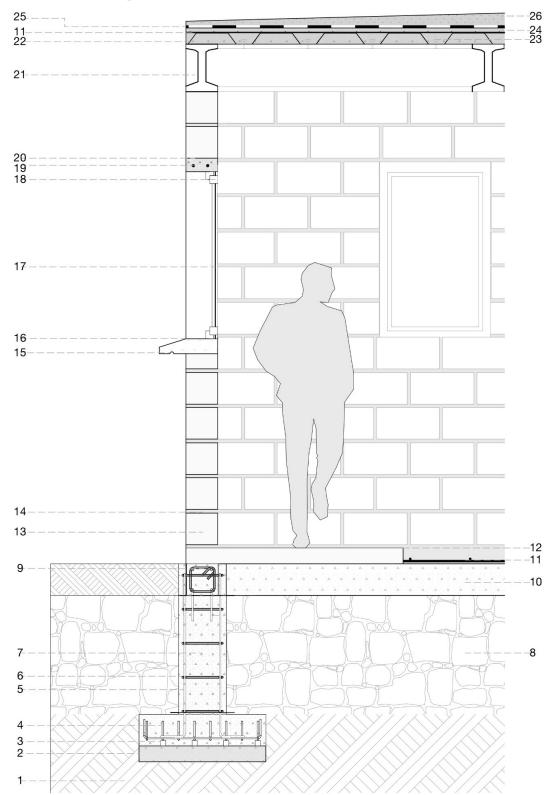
Sección constructiva vivienda convencional de estructura de hormigón y cerramiento de bloque.
